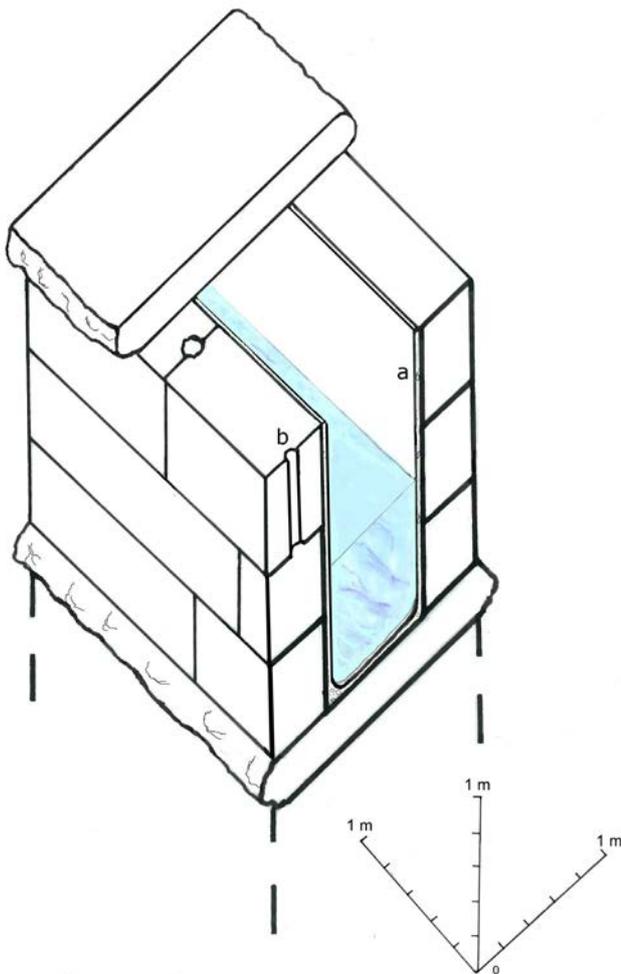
AREA 1. Assonometria ricostruttiva del condotto, da Sud. In particolare: a) prima barriera impermeabilizzante; b) seconda barriera (rilievo in scala 1:50 dell'A., 2019).
